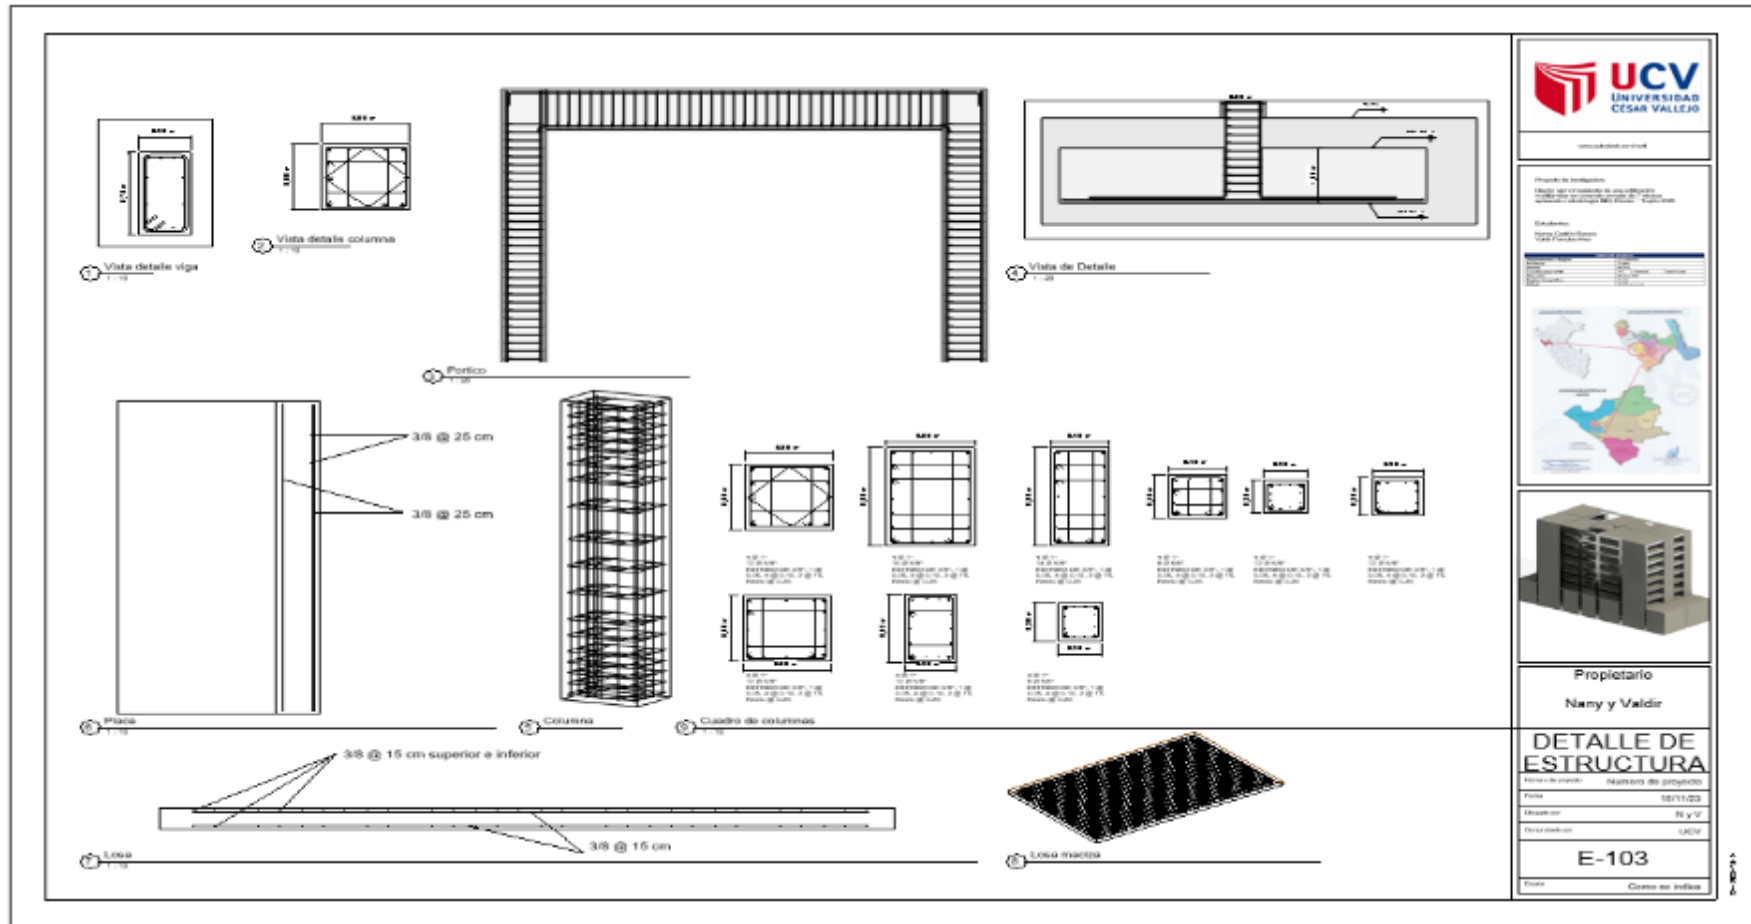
Detalles de los elementos estructurales de la edificación con Revit
